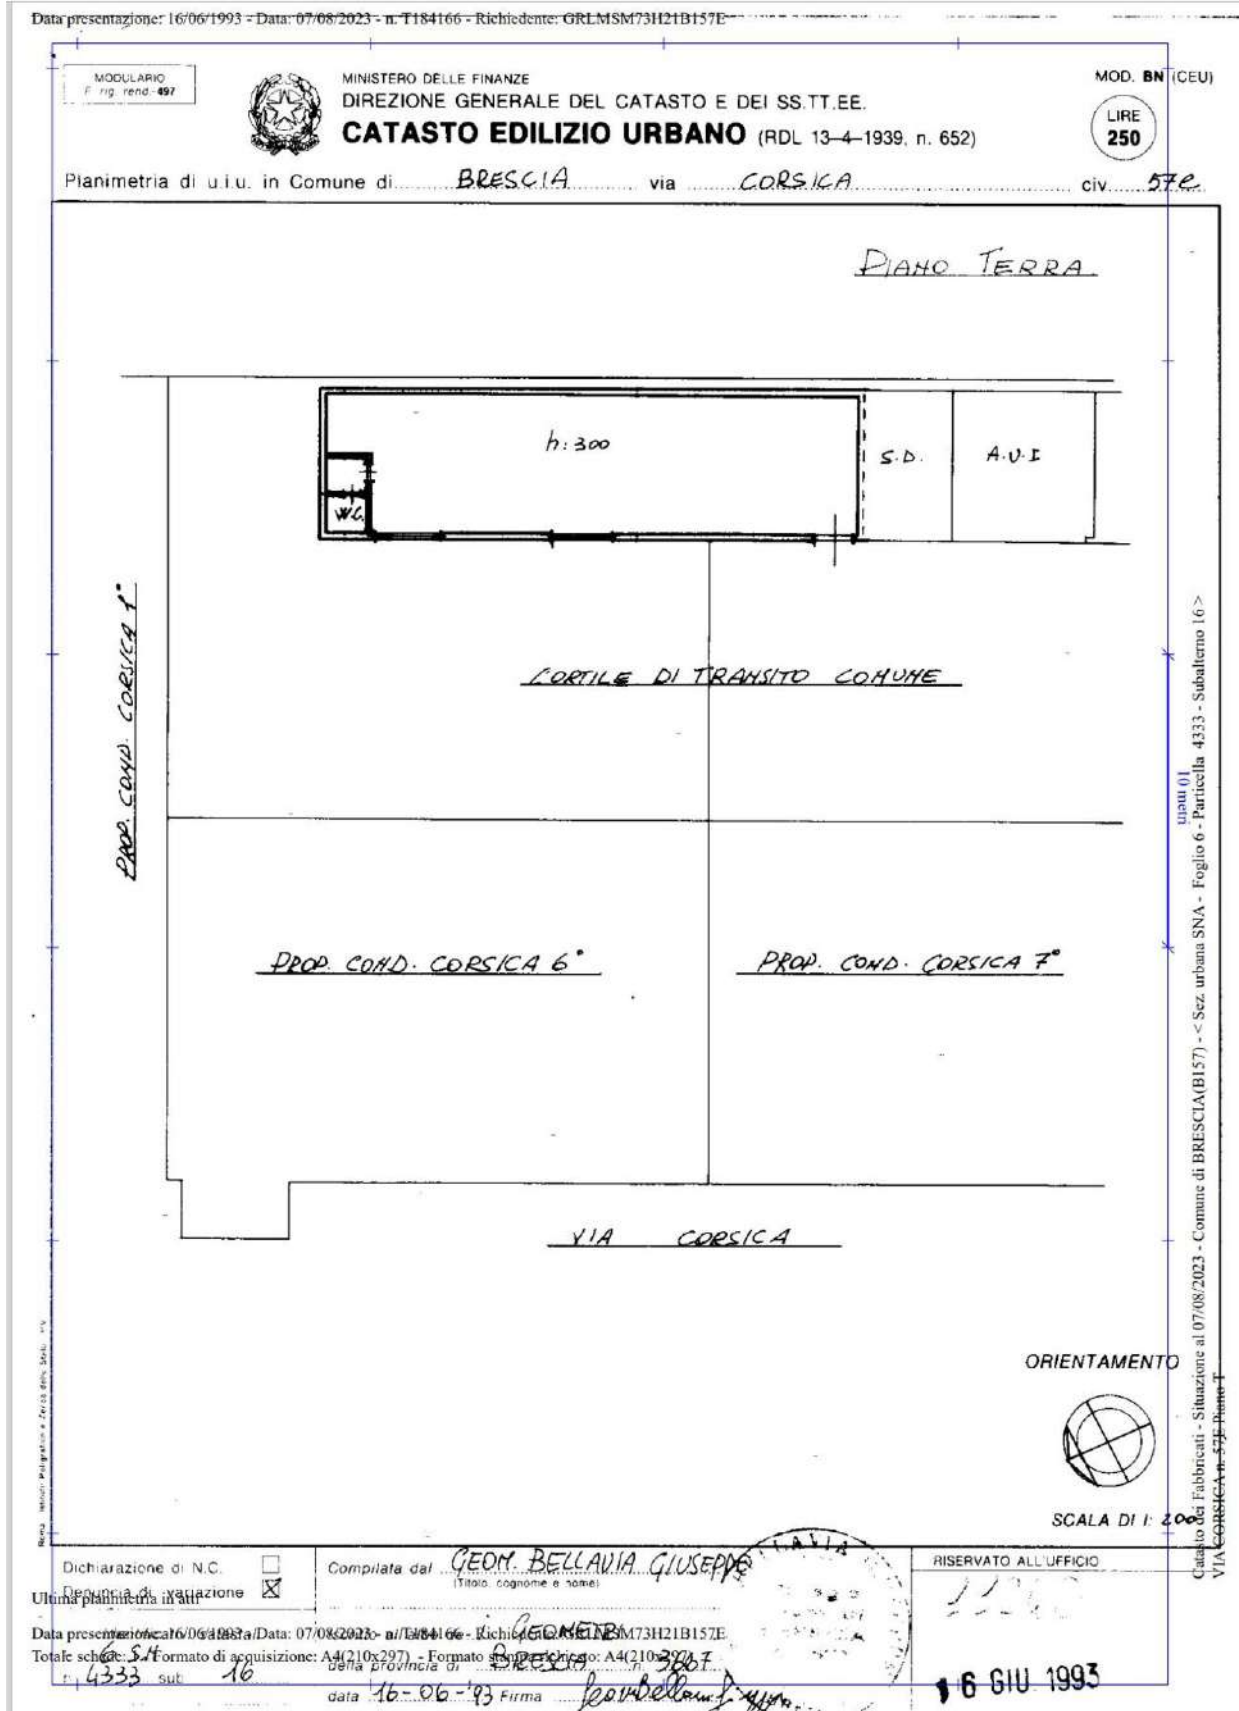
Planimetria catastale ultima in atti del 1993
